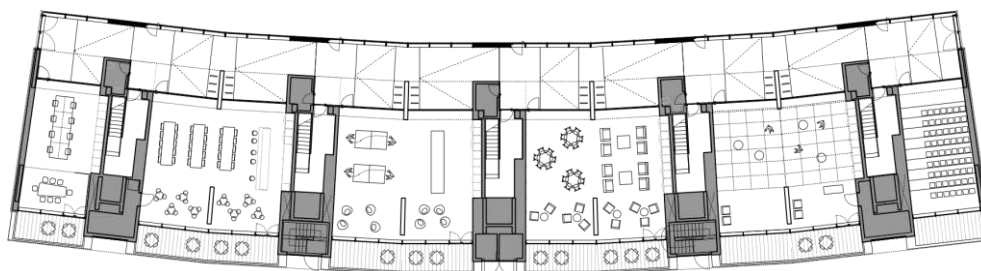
Planta baja, locales comunitarios y portales. Fuente: Elaboración propia.
